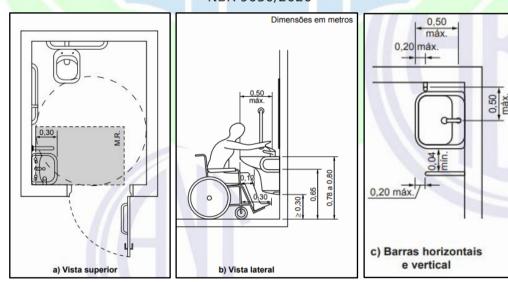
Dimensões para instalação das barras de apoio para lavatório conforme NBR 9050/2020
